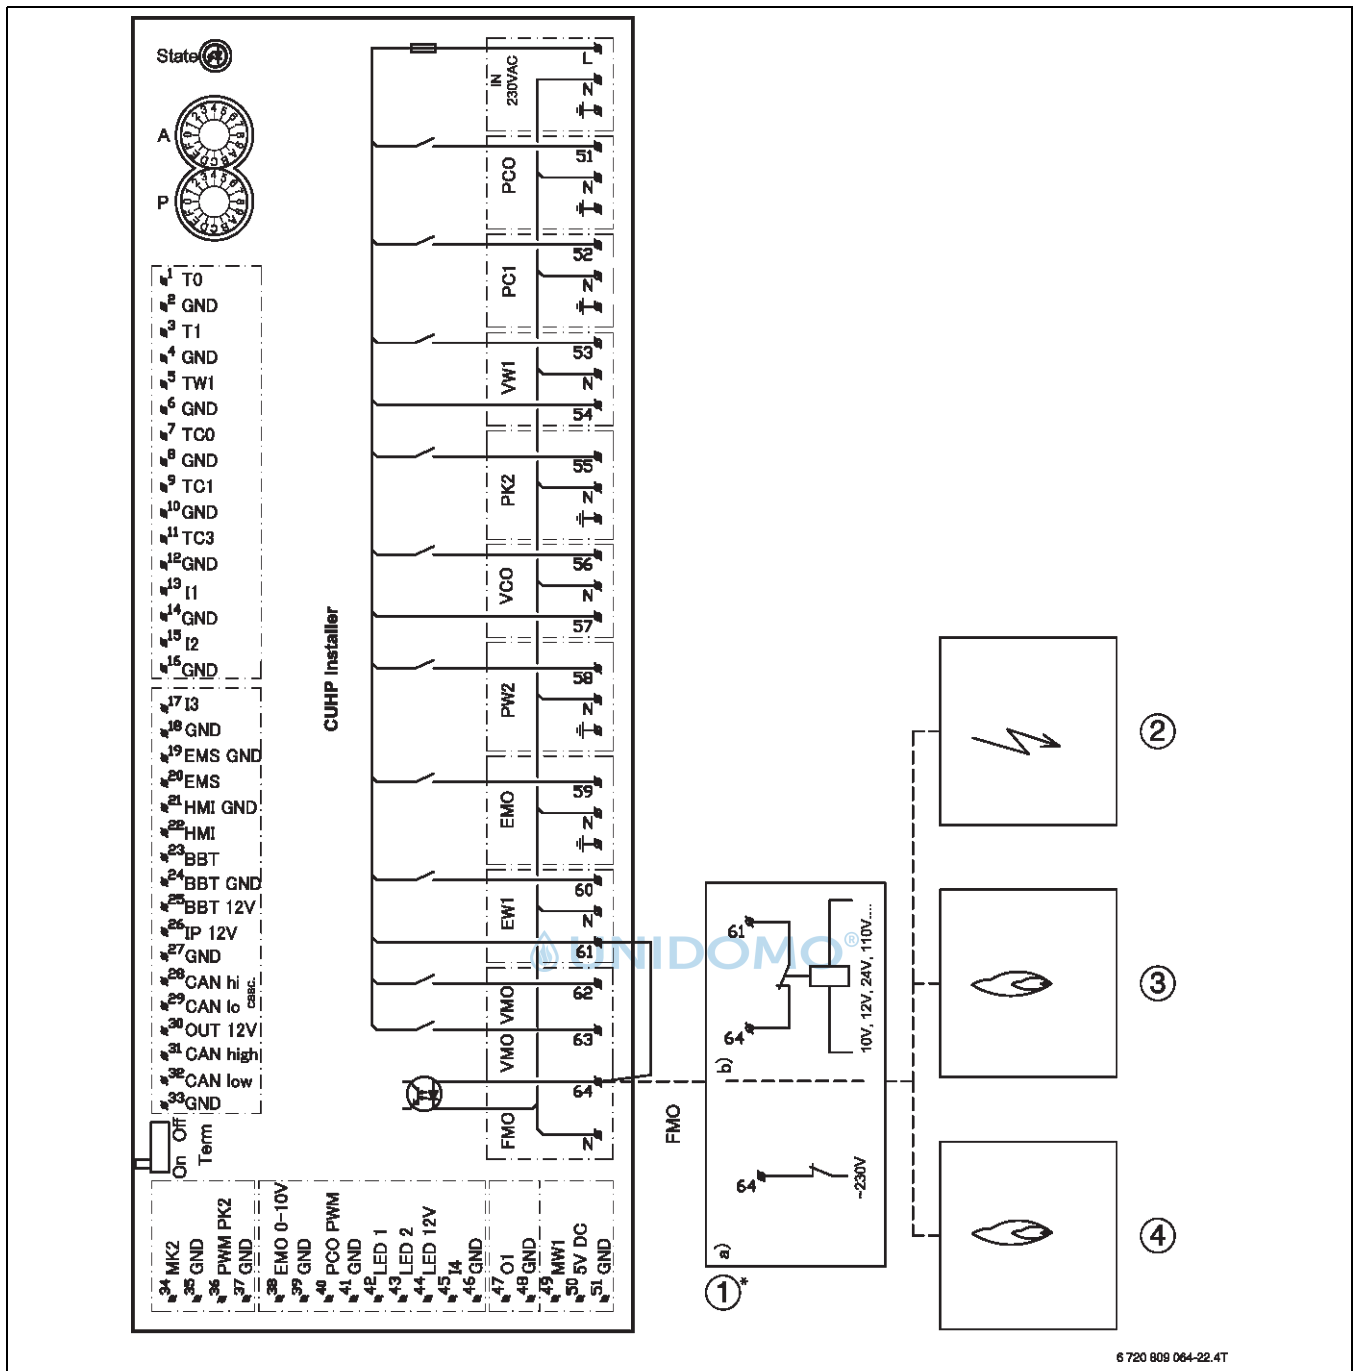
Schaltplan Installationsmodul, Alarm des Heizkessels
